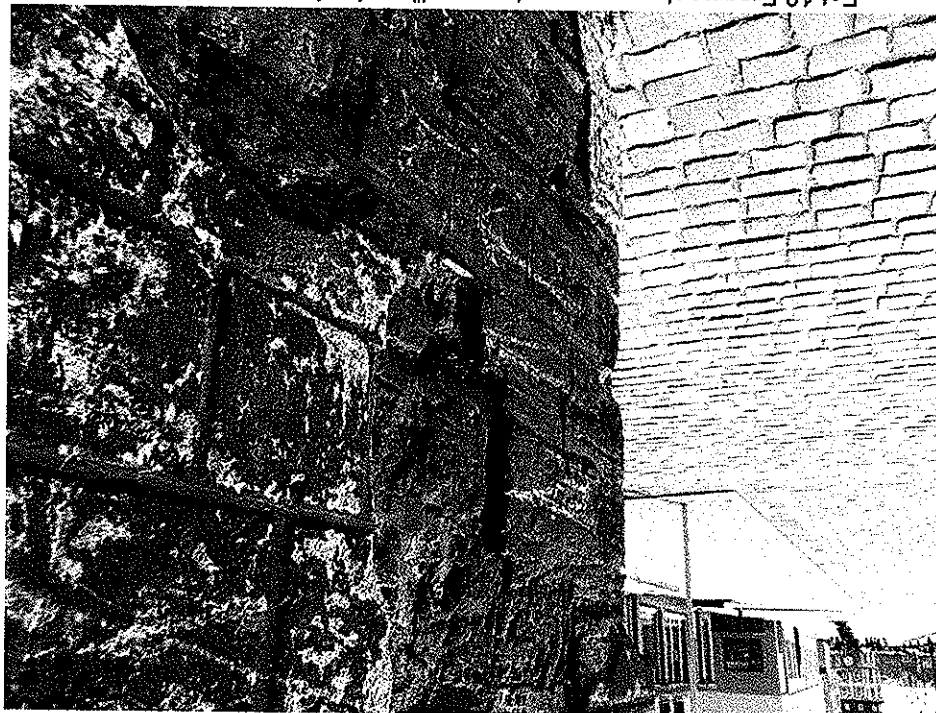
Zarzucone zaprawą belki sklepienia wnętrza Bramy
